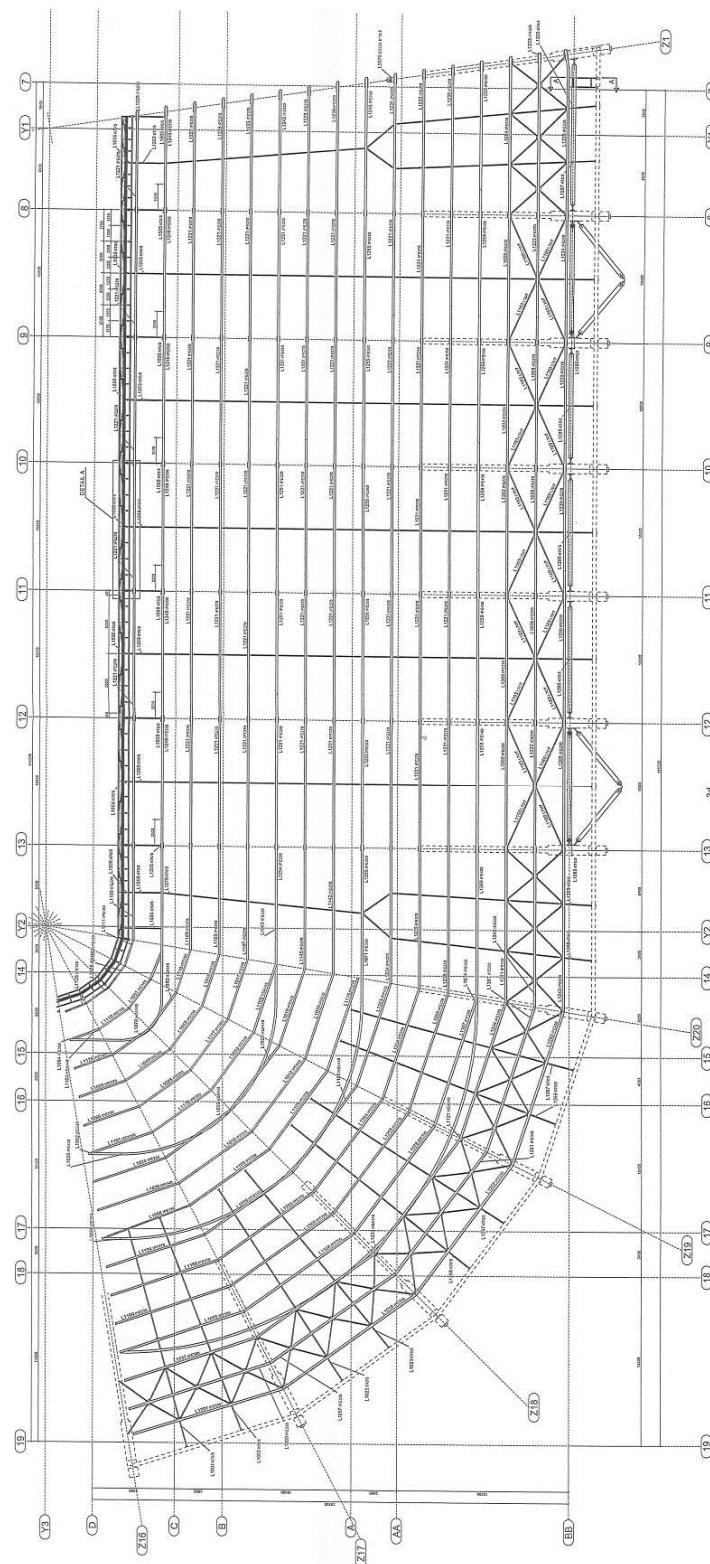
Bovenaanzicht dakconstructie [T.09]
